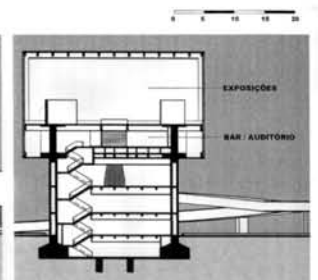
CORTE TRANSVERSAL DO "OLHO"
